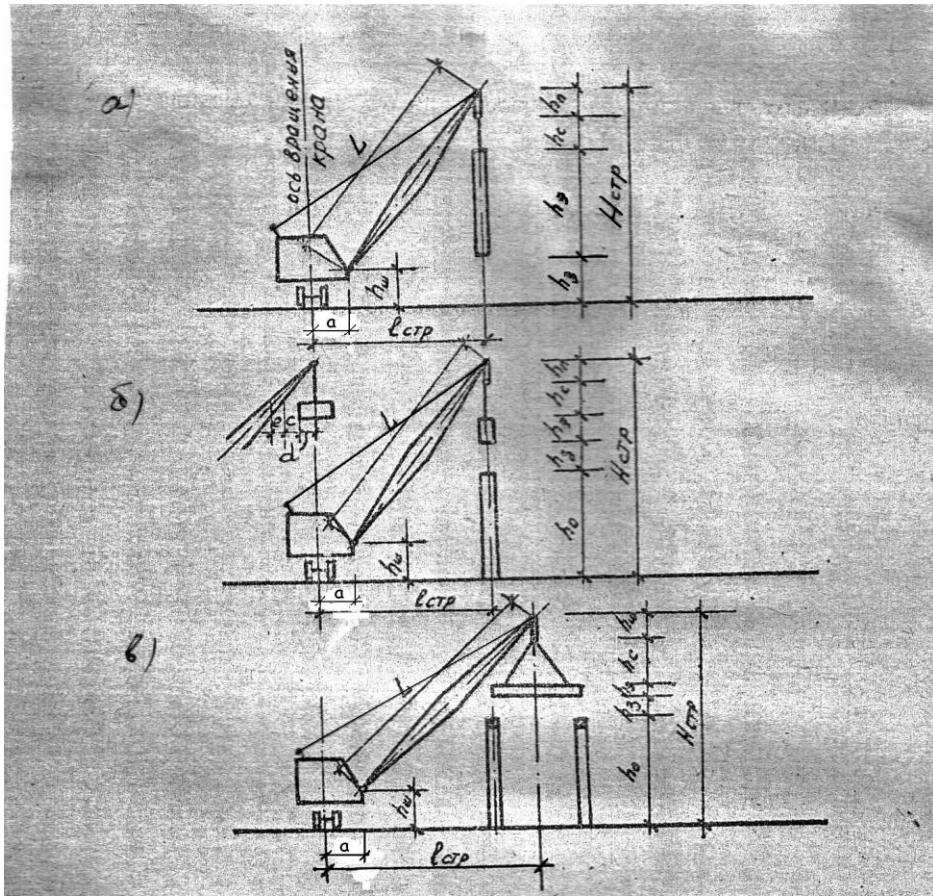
Схемы для определения параметров самоходного крана при монтаже: а) колонн; б) ферм или балок покрытия; в) плит покрытия.
